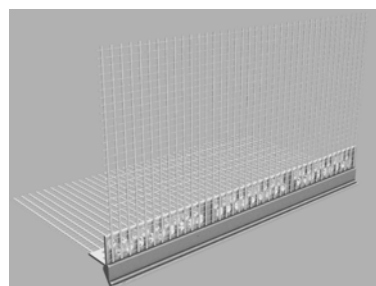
Instalación del aislamiento y detalle de solape de la malla de armadura en una ventana.
